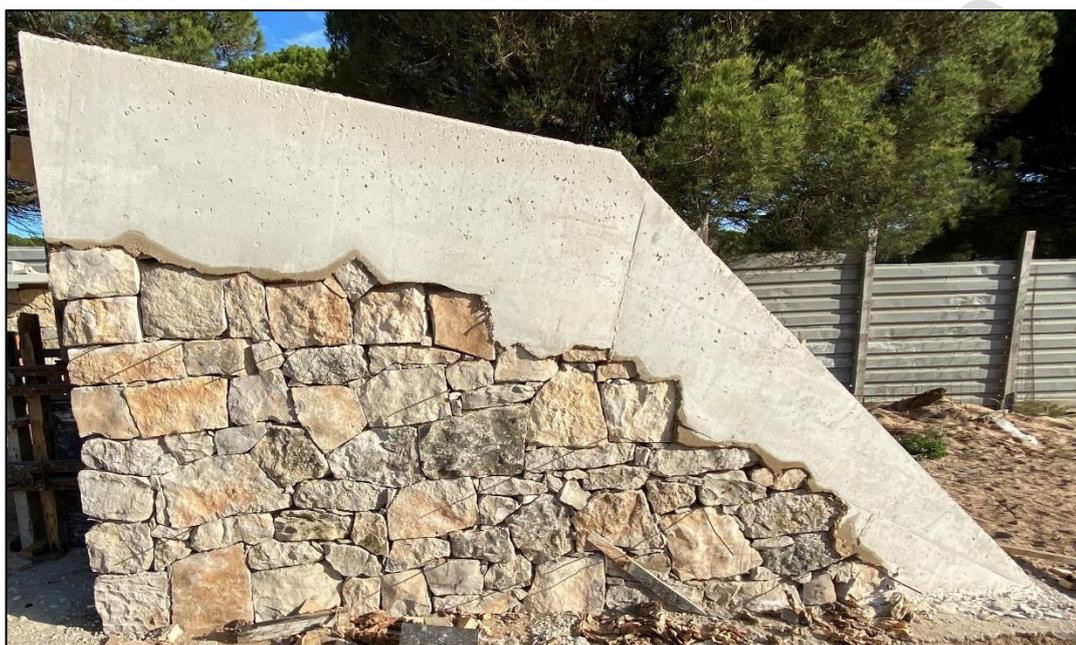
Amostra final de ligação de betão branco com muro de pedra rústica emparelhada.
